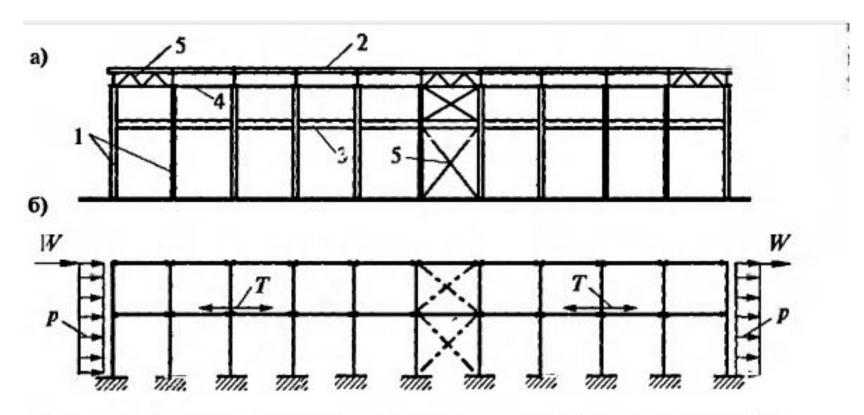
Продольная рама: а) конструктивная схема; б) расчетная схема продольной рамы; 1— колонна; 2— плита покрытия; 3— подкрановая балка; 4— распорки; 5— вертикальные связи
